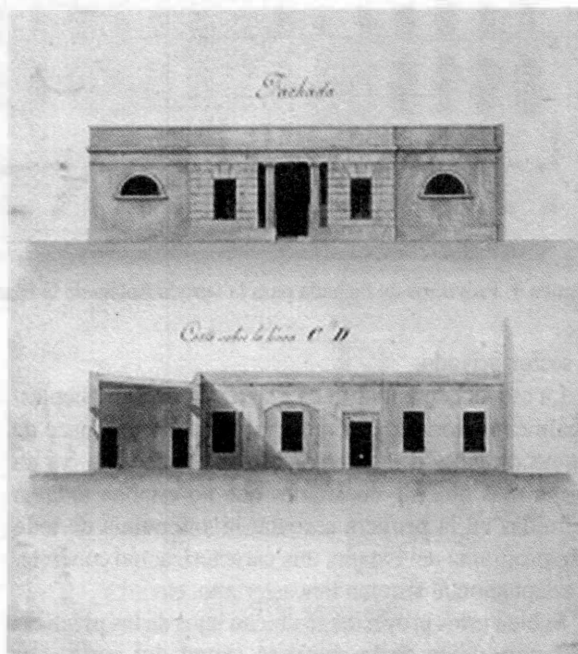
Detalle de la fachada de la escuela en la parroquia de San Nicolás. Proyecto de Zucchi, 1831. Fuente: ASRE AZ
